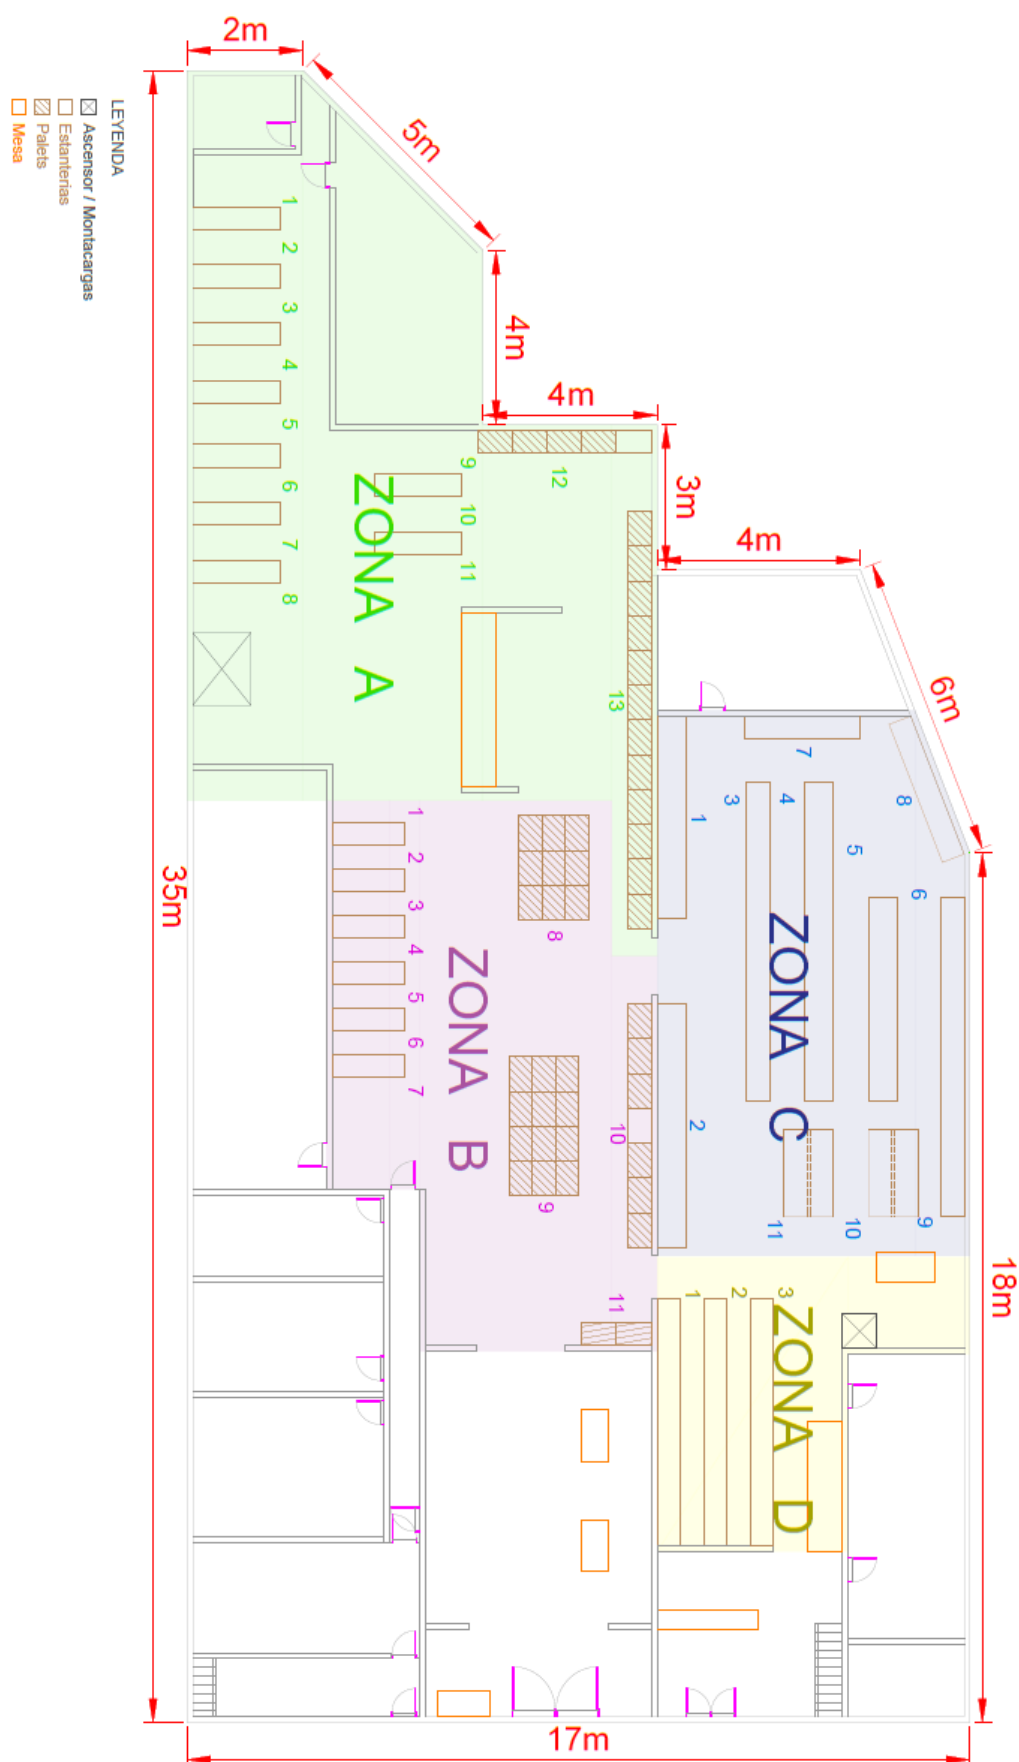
Imagen del plano de la planta baja por zonas (Anexo D: P004)
